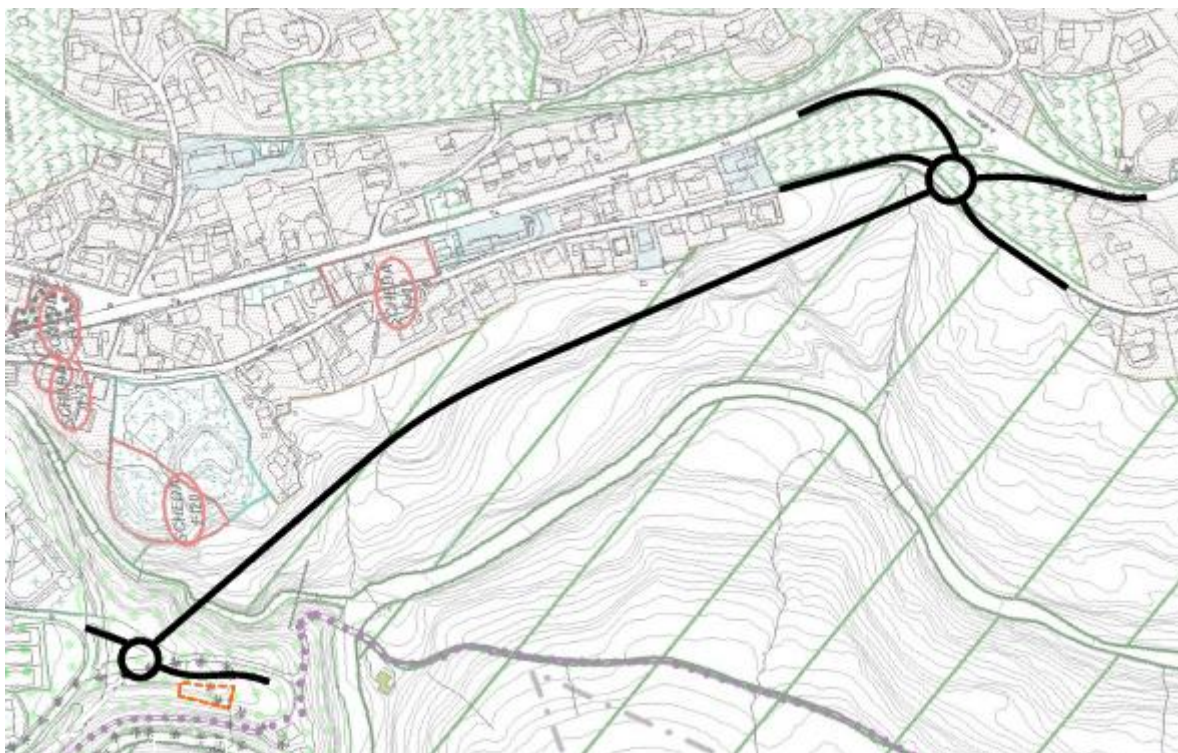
Stralcio planimetrico PRG con individuazione del deposito temporaneo / aree di stoccaggio
